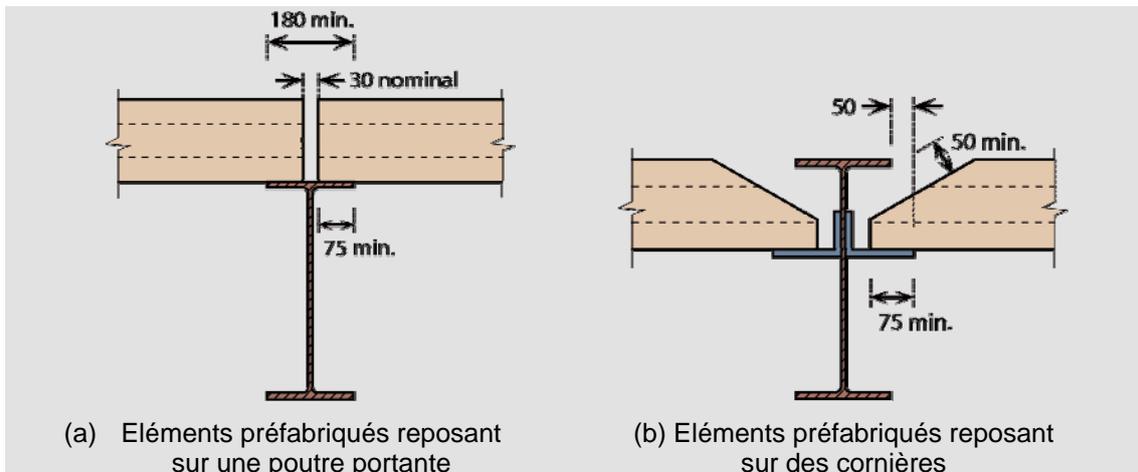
Plancher constitué d'éléments préfabriqués non mixtes
